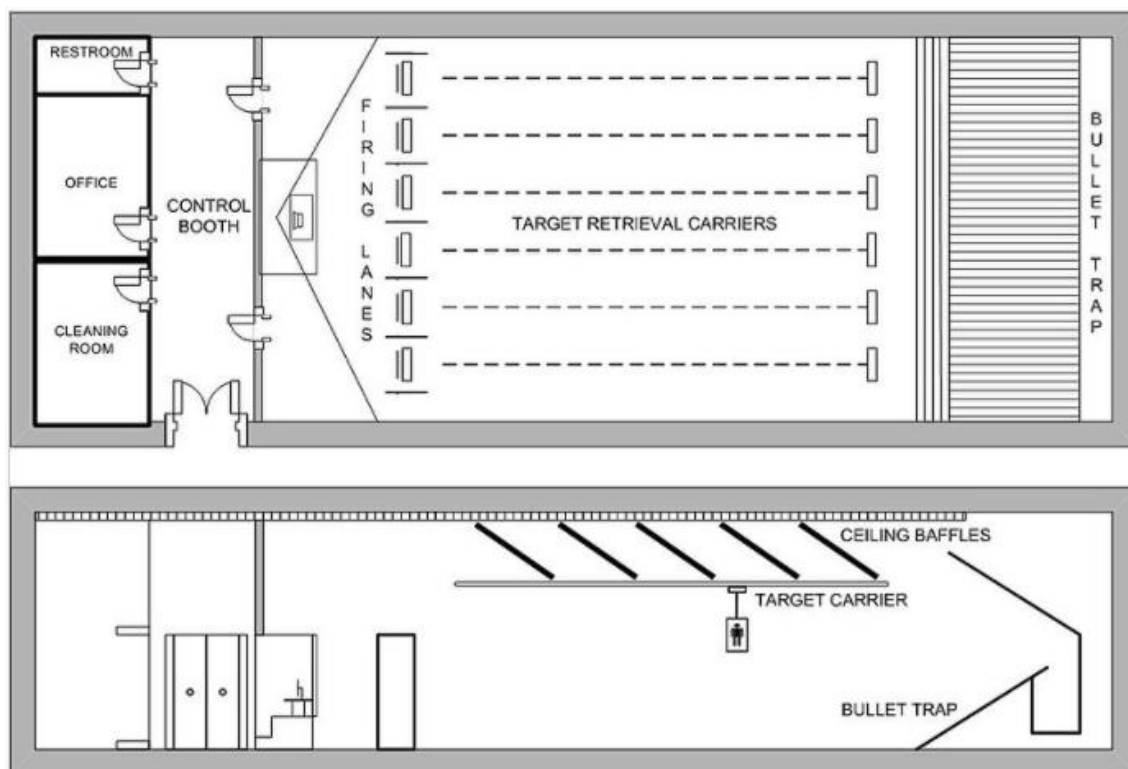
Planta baixa e diagrama seccional de Estande de tiro típico.
